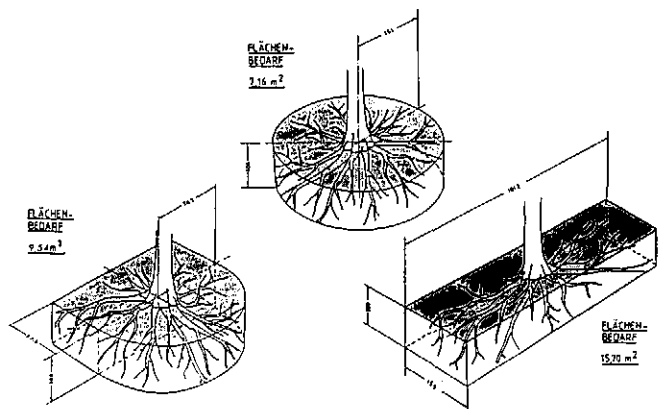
Fundamentformen und Standflächenbedarf, nachgewiesen an einem bestimmten Baum mit einer Windangriffsfläche von 60 m²
